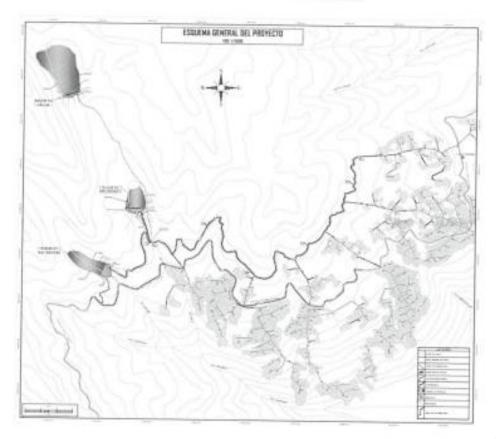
PLANTEAMIENTO HIDRAULICO
